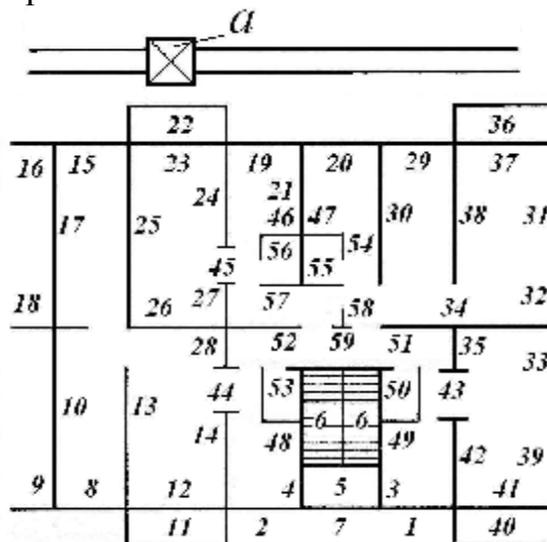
Схема установки панелей в бескаркасных зданиях с поперечными несущими стенами: *a* – монтажный кран; 1, 2, 3... – порядковый номер очередности установки панелей
